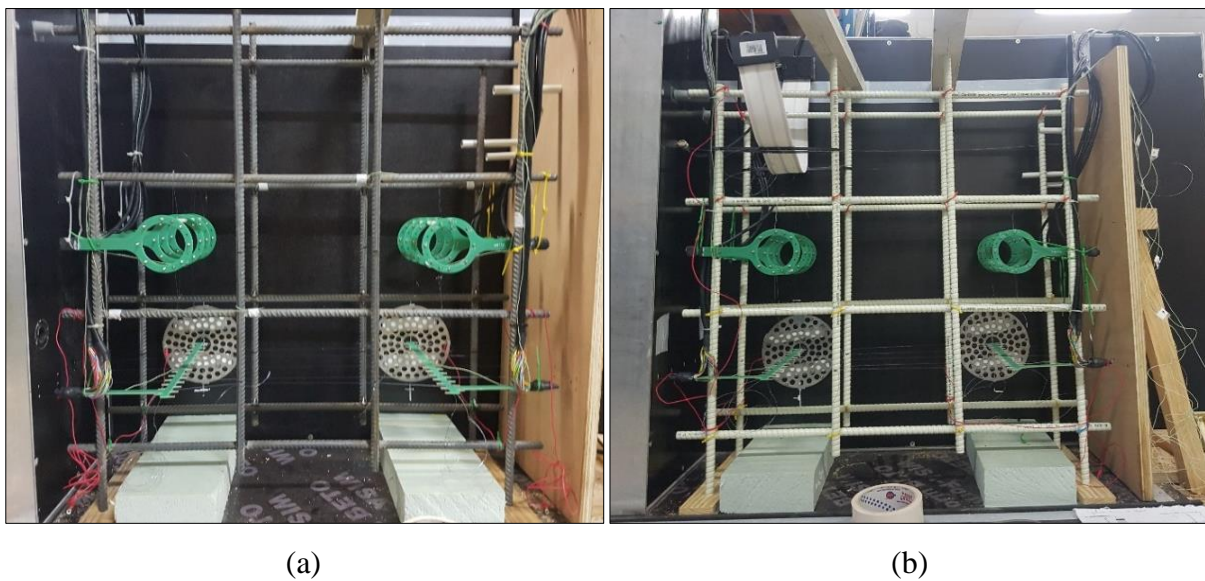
Vue des moules des dalles avant coulage, avec lits d'armatures et instrumentation : (a) dalle HA, (b) dalle FV.
